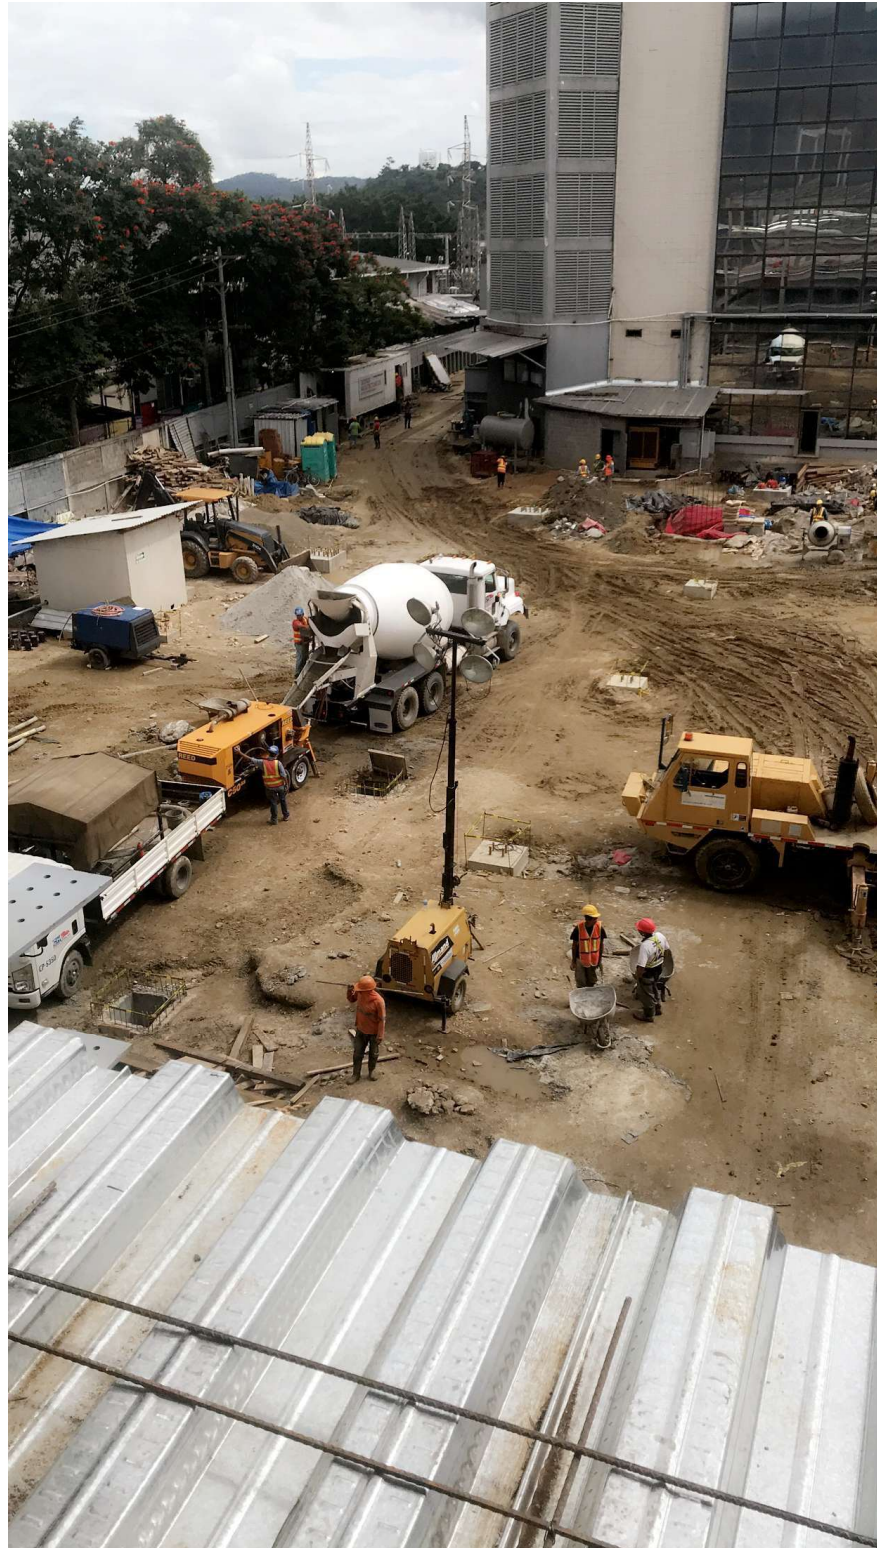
Llegada de Viguetas a Proyecto de José Cecilio del Valle.
